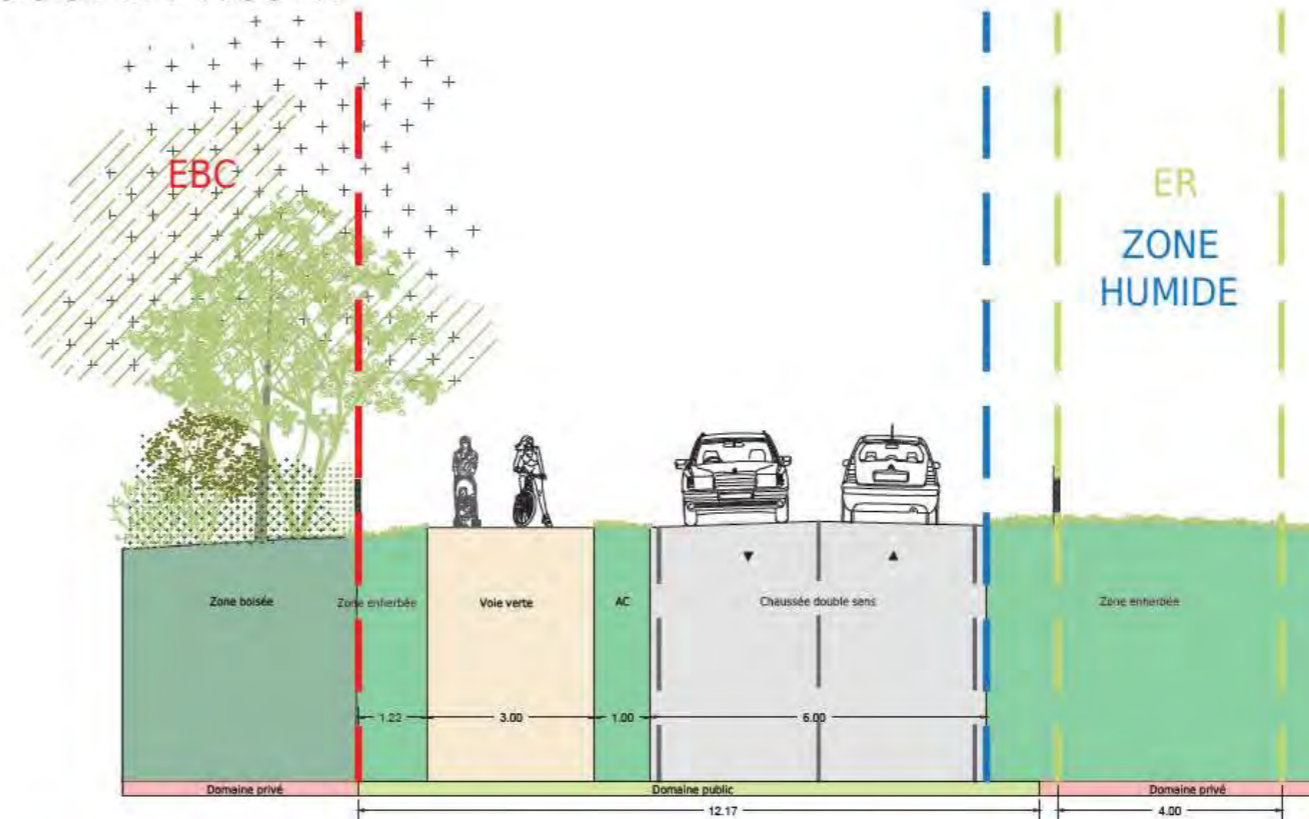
Avenue de Pagnot – Section nord– Plan projet et coupes
